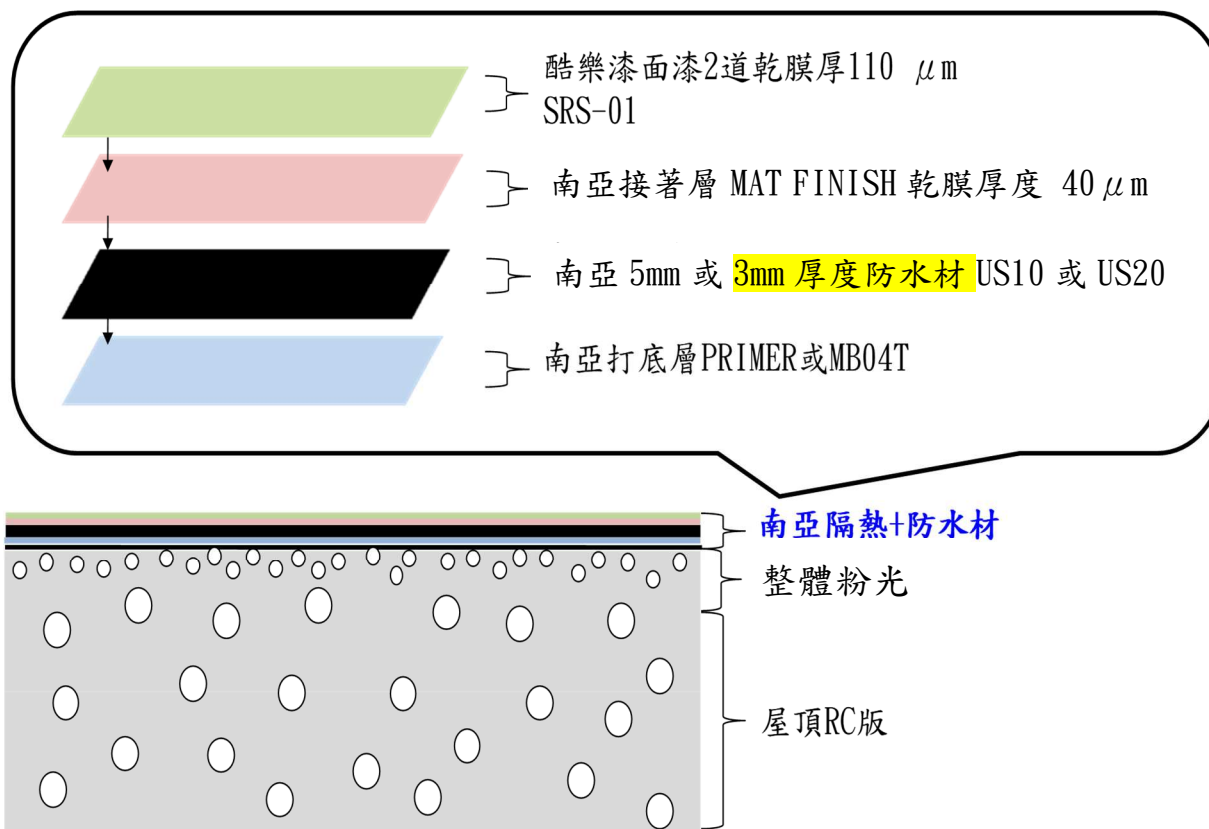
南亞防水隔熱材塗佈屋頂 RC 面的施工結構示意圖
